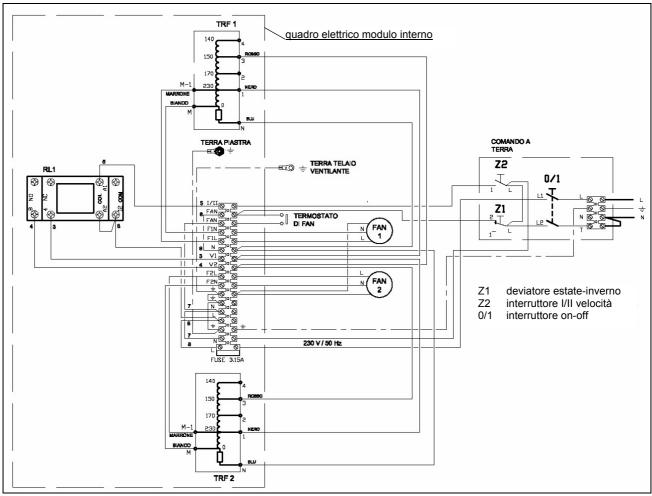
SCHEMA COLLEGAMENTI ELETTRICI MODULO INTERNO
